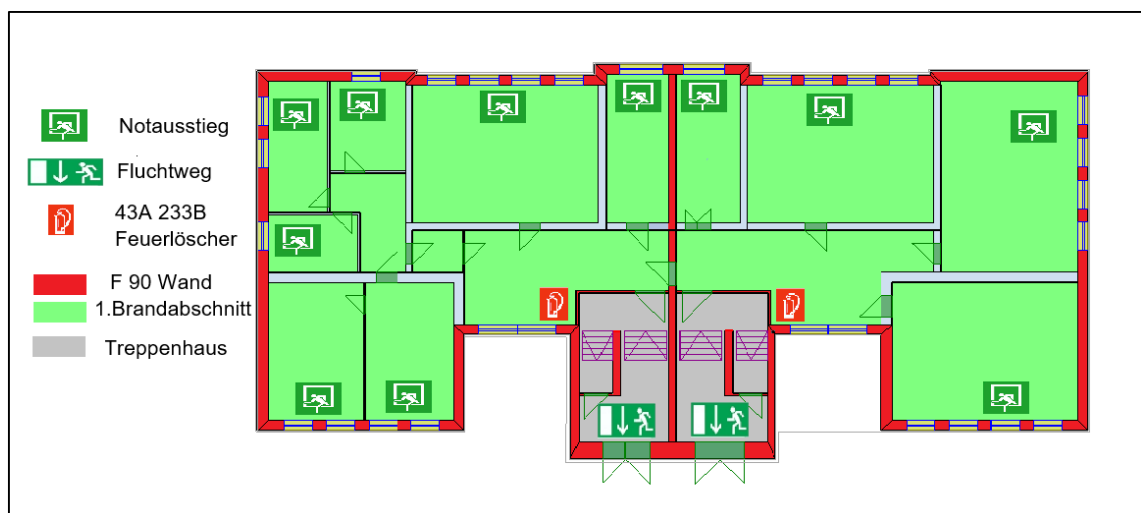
| Flucht und Rettungswegeplan für das Erdgeschoss
